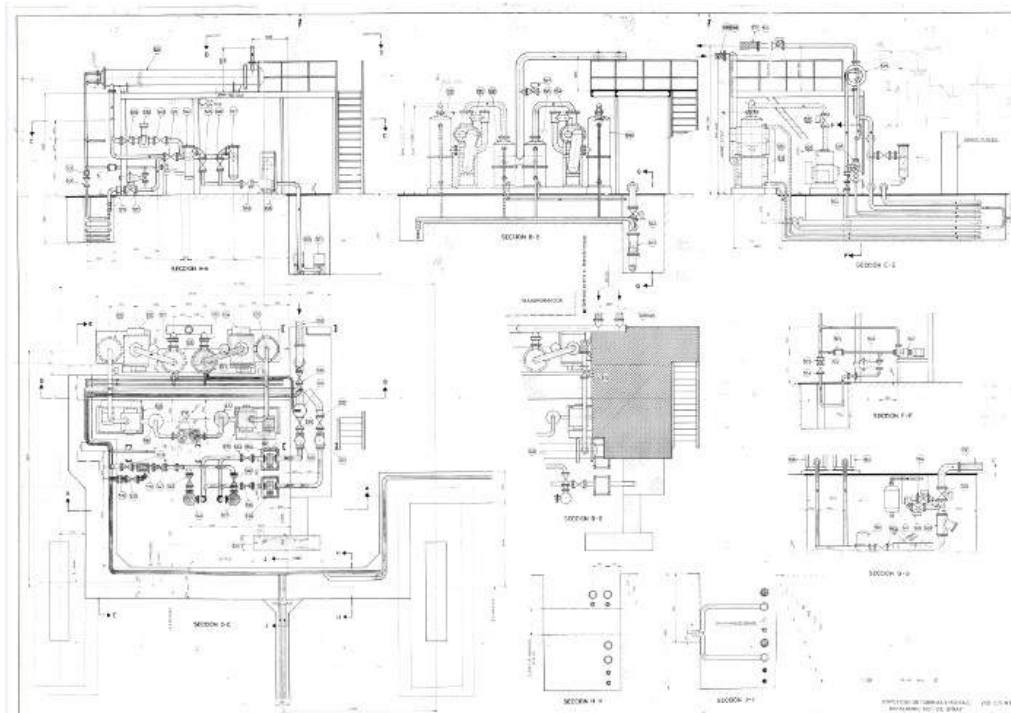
Plano equipos Hot oil spray. Vista 2.
